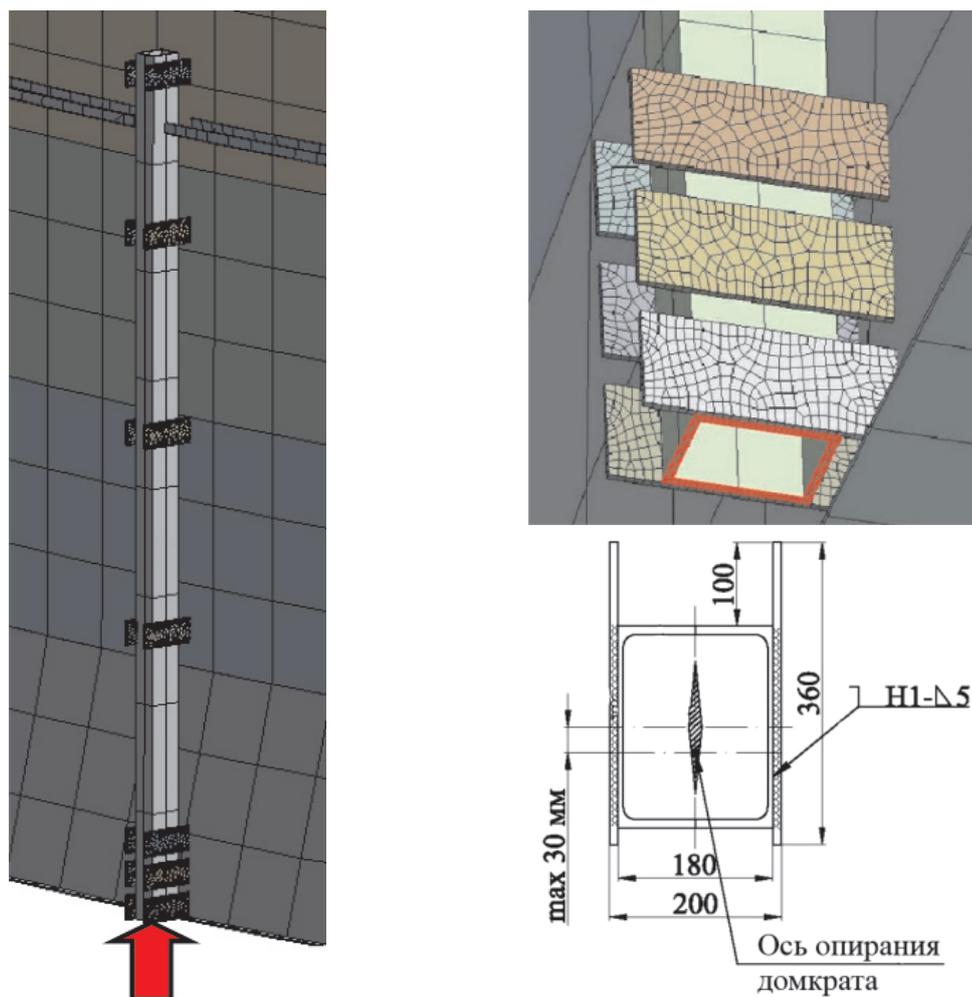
Приложение сосредоточенной нагрузки к опорной раме от гидродомкрата
